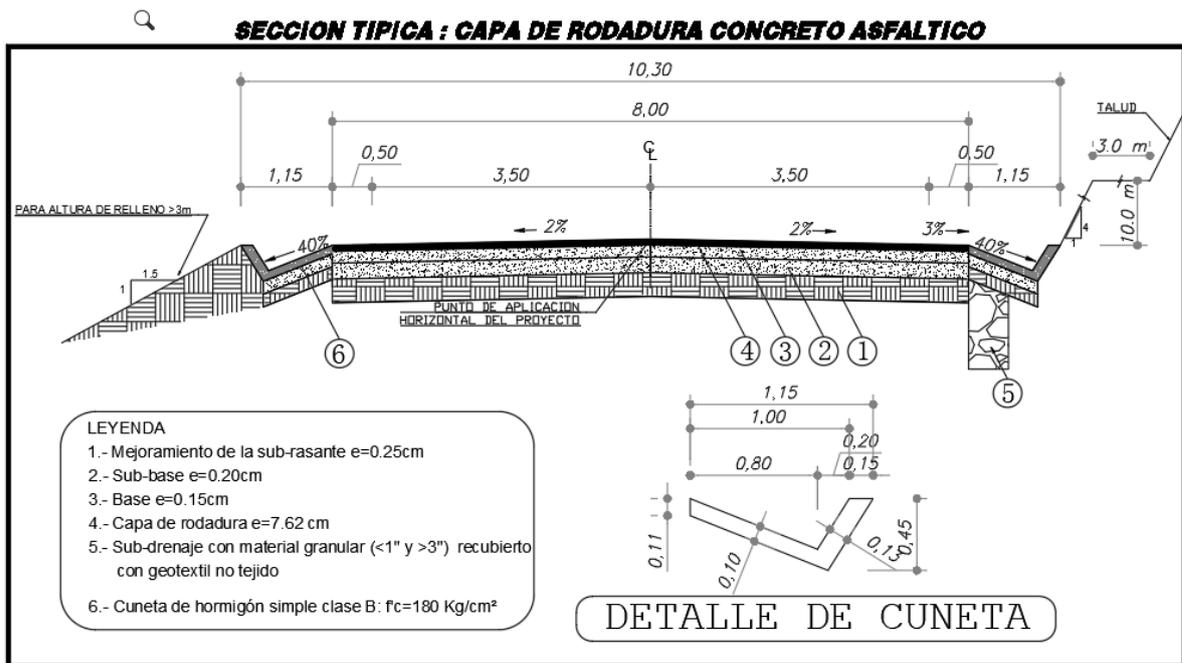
PAVIMENTO FLEXIBLE: tramo 2 (9+000 – 26+000), tramo 3 (26+000 – 36+000)
